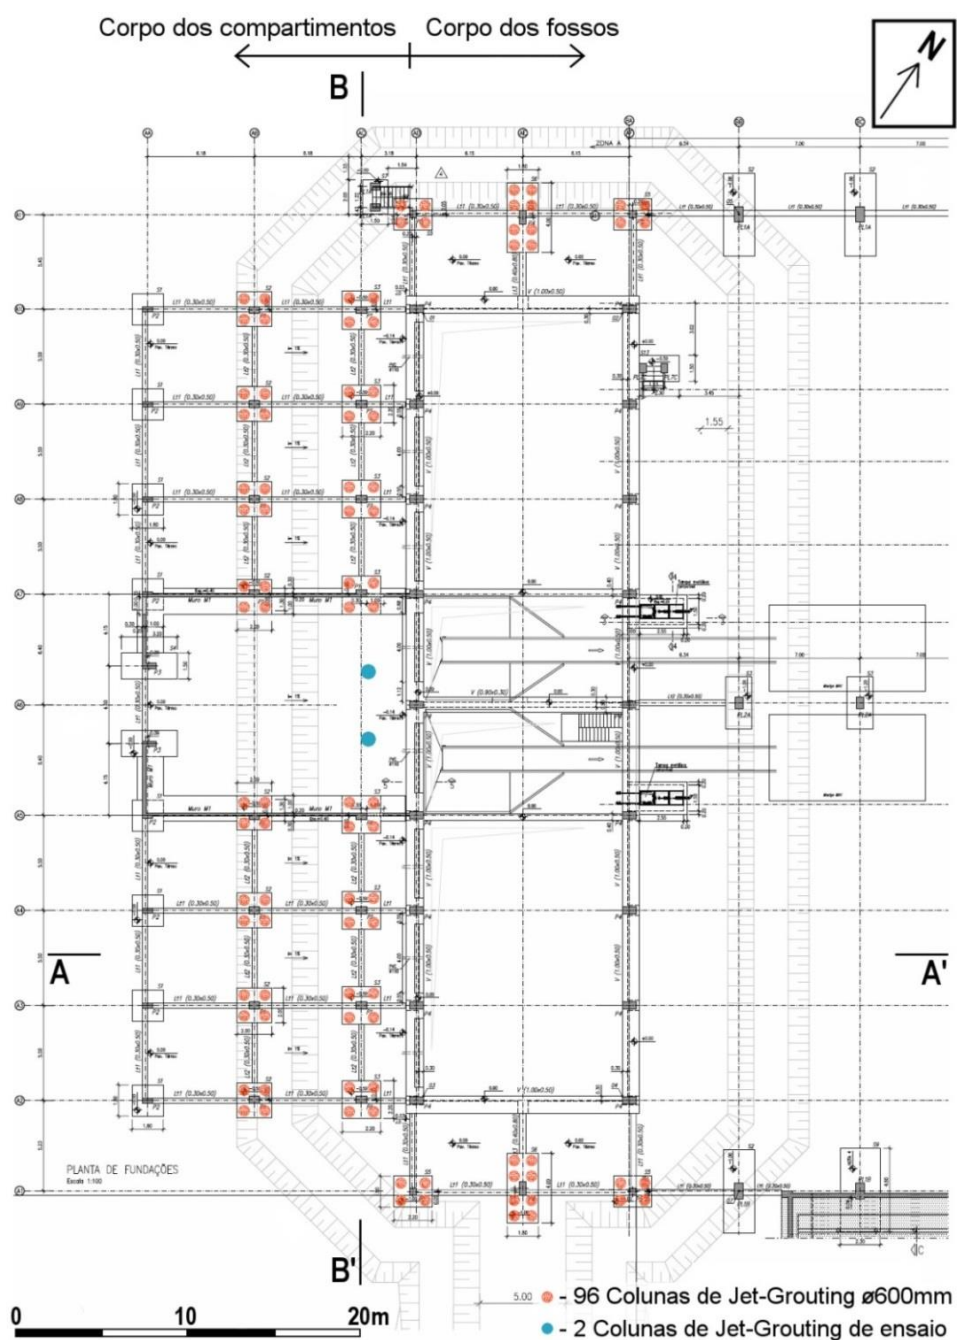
Planta com a localização das colunas verticais de *jet grout* projectadas para a Zona 1 (adaptado de Edifer, 2011b)
